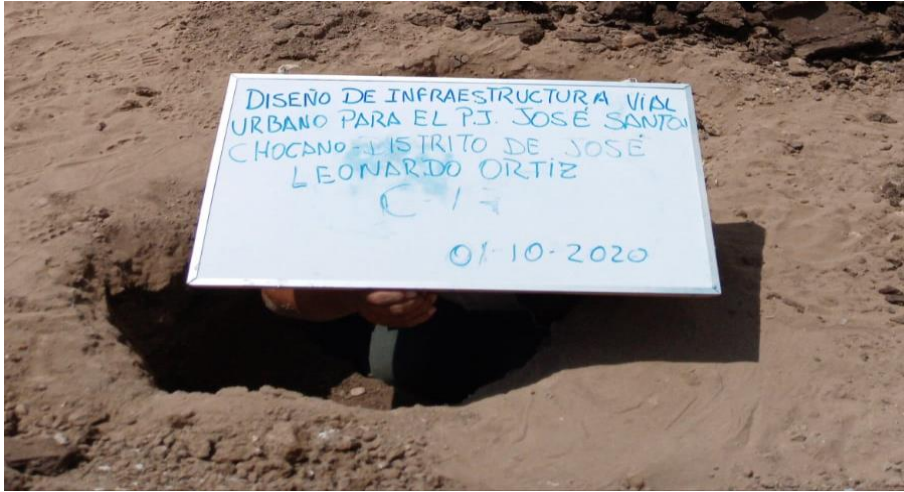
Vista a cielo abierto de la excavación en C - 02
